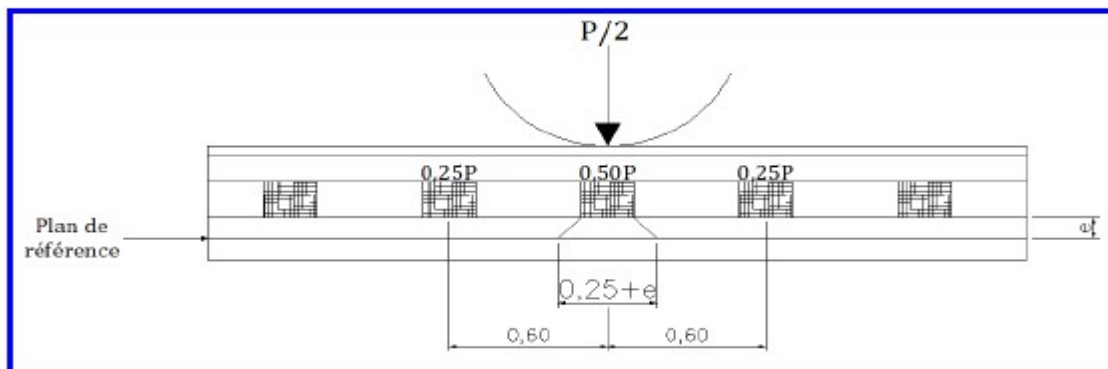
répartition longitudinale d'une roue sur voie sans ballast
